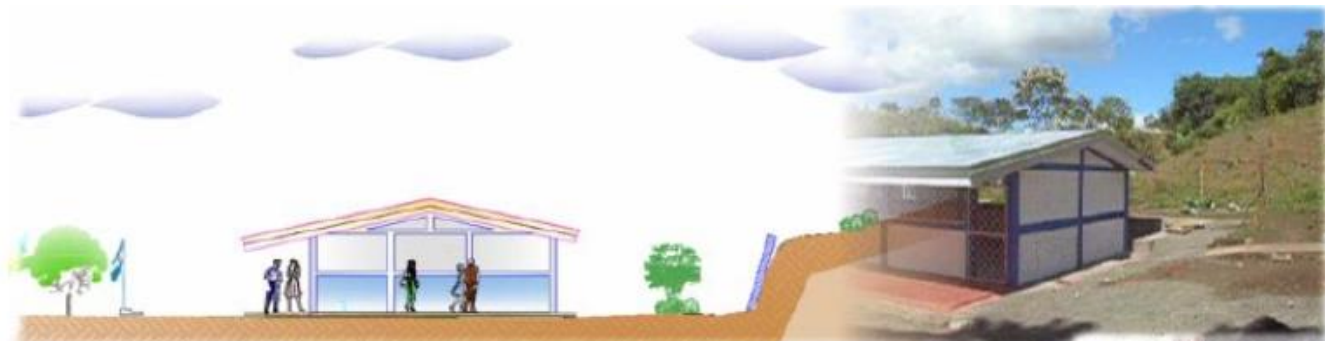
Terreno que permite la construcción de centro escolar. Fuente: MINED
